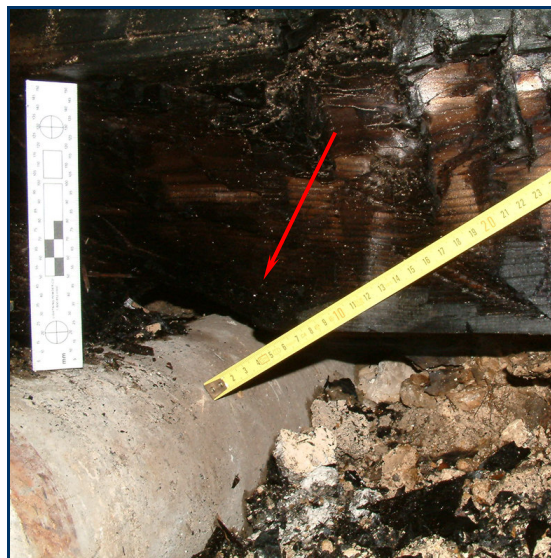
Poutre évidée pour permettre le passage du tuyau de raccordement à travers le mur.
